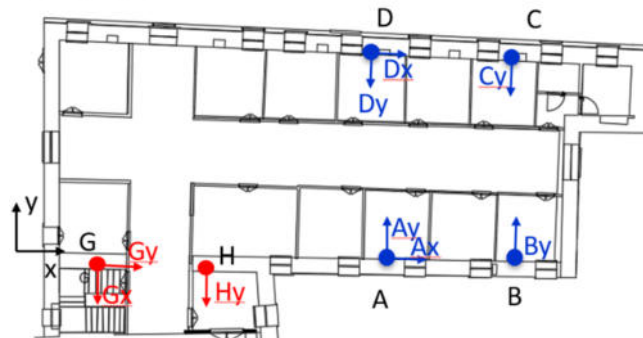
Disposizione accelerometri nel piano secondo dell'edificio.
